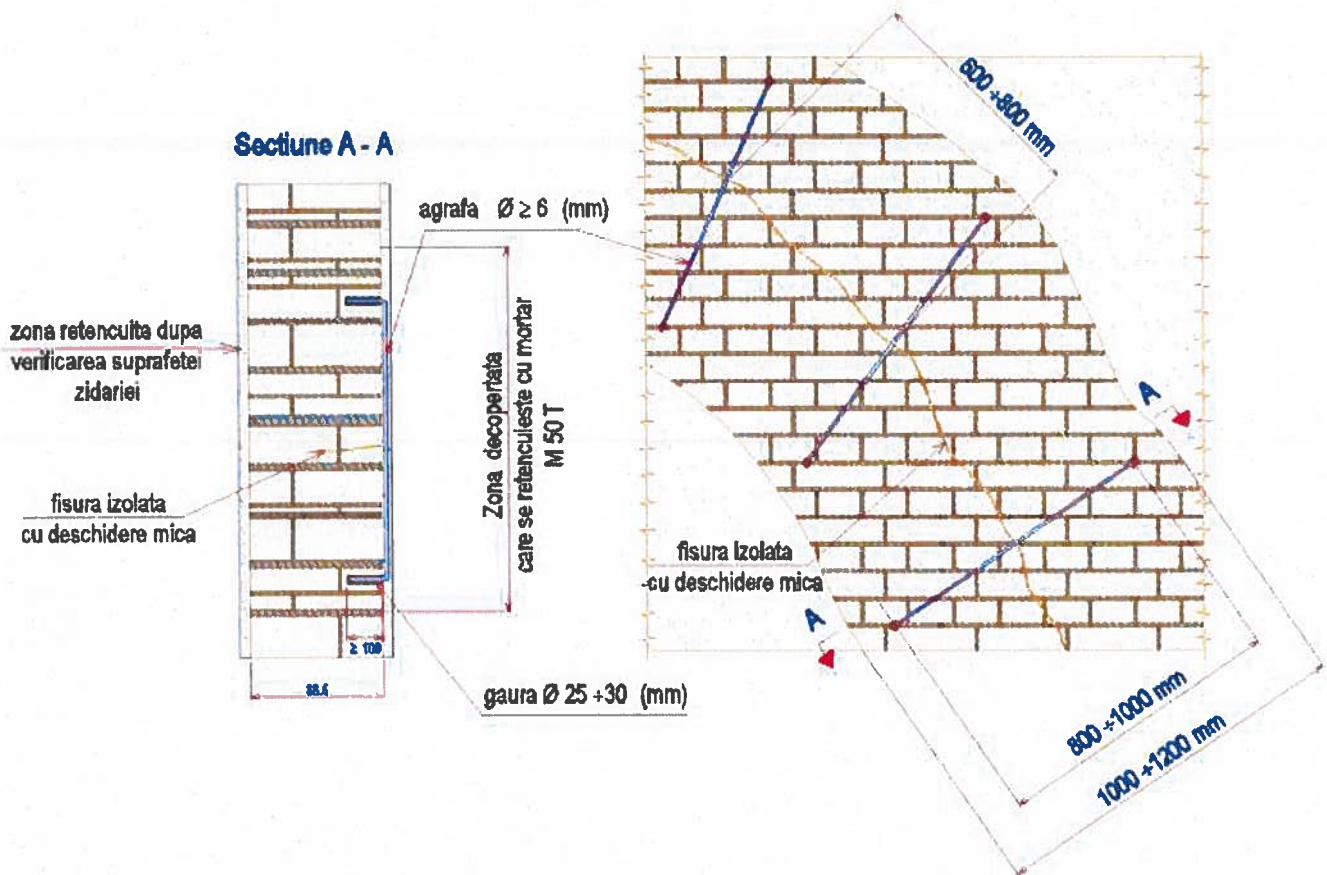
Repararea unei zidării de 1 și 1/2 cărămidă grosime fisurată local pe o față, cu ajutorul agrafelor din oțel – beton. Vedere în plan și secțiune.
